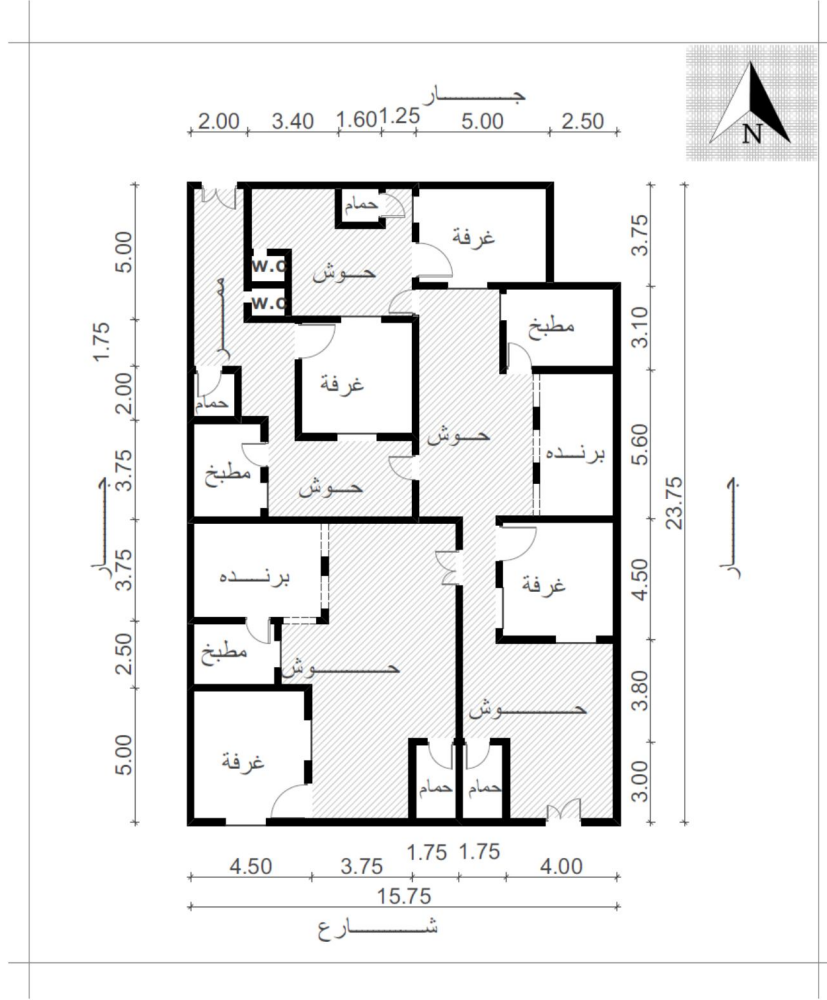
مسقط أفقي لحالة الدراسة السادسة (المصدر: الباحثة)
